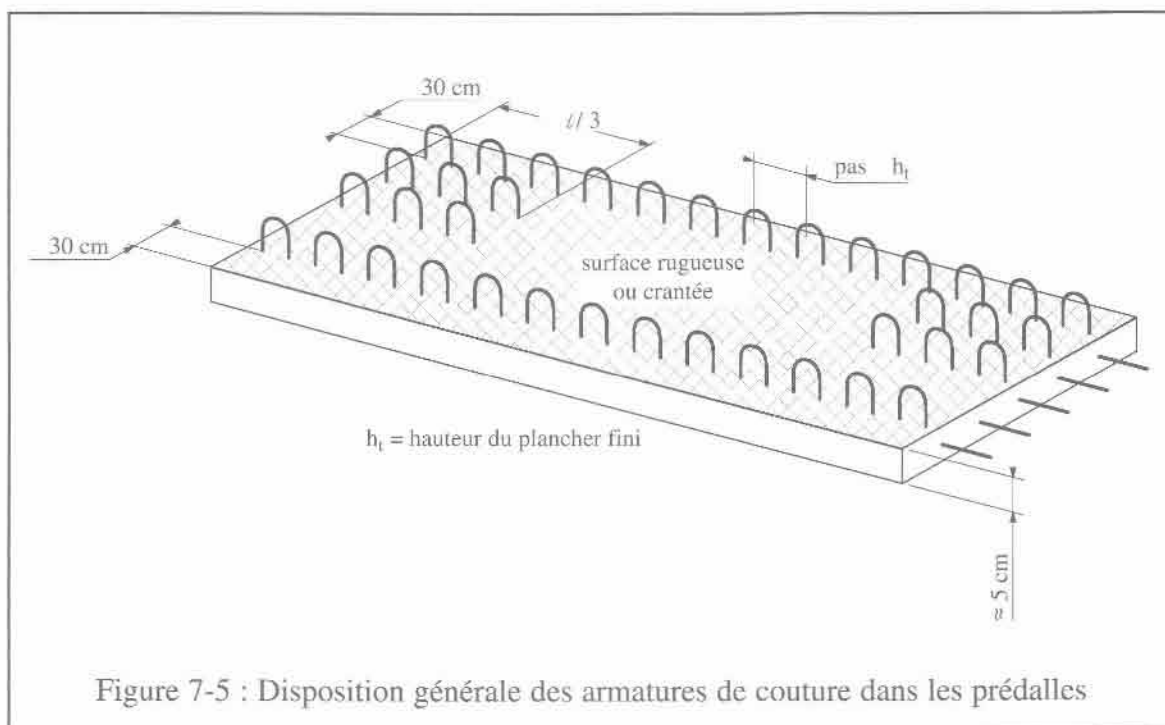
Disposition générale des armatures de couture dans les prédalles
